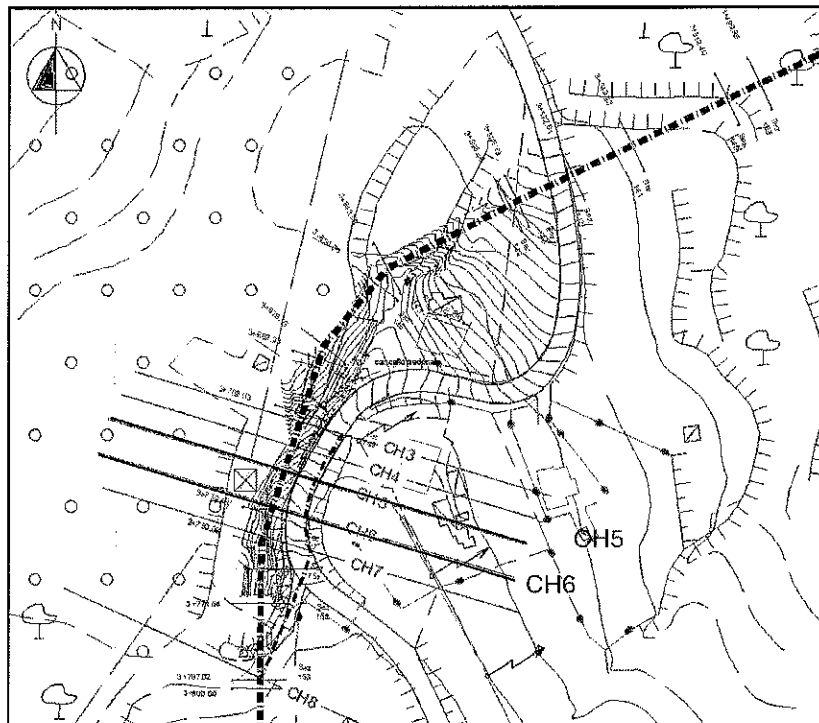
Planimetria con indicazione del tracciato originario della condotta (in rosso) e delle sezioni di calcolo (CH5 e CH6)
